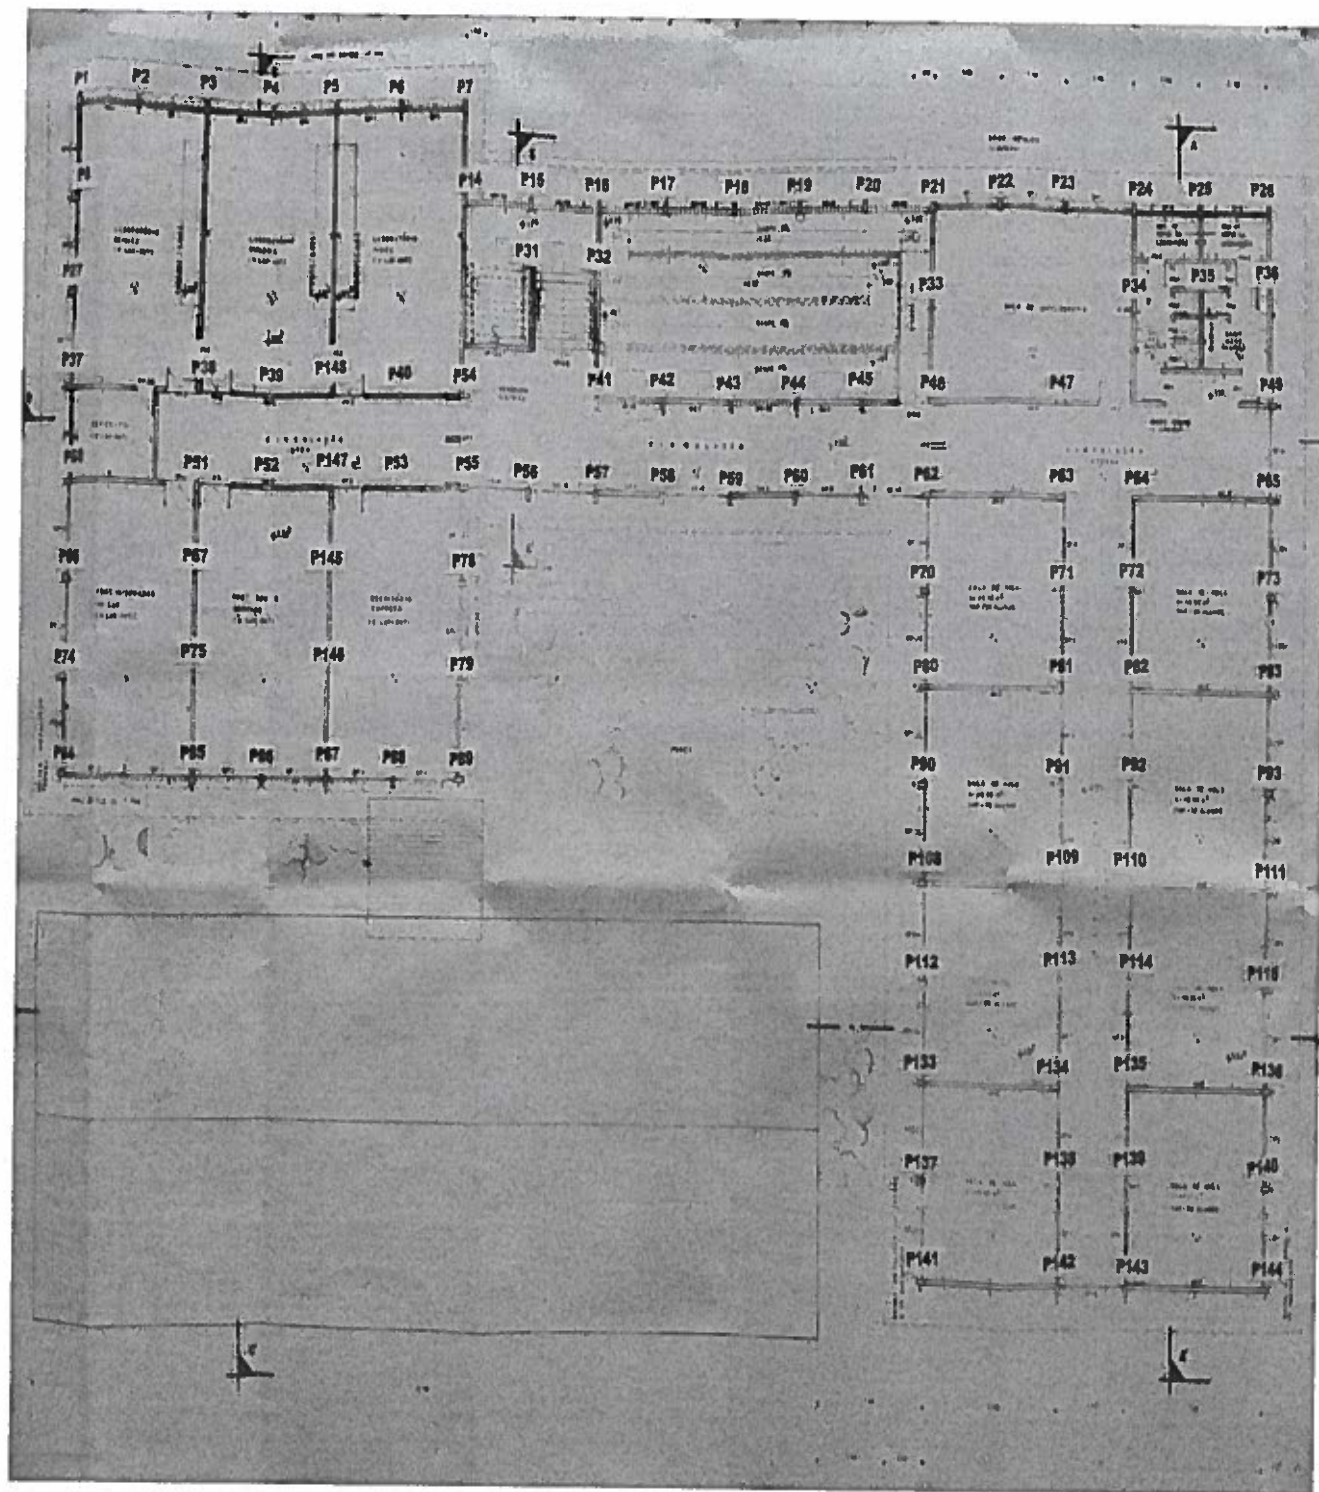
Planta Baixa 1º pavimento – Numeração dos Pilares
